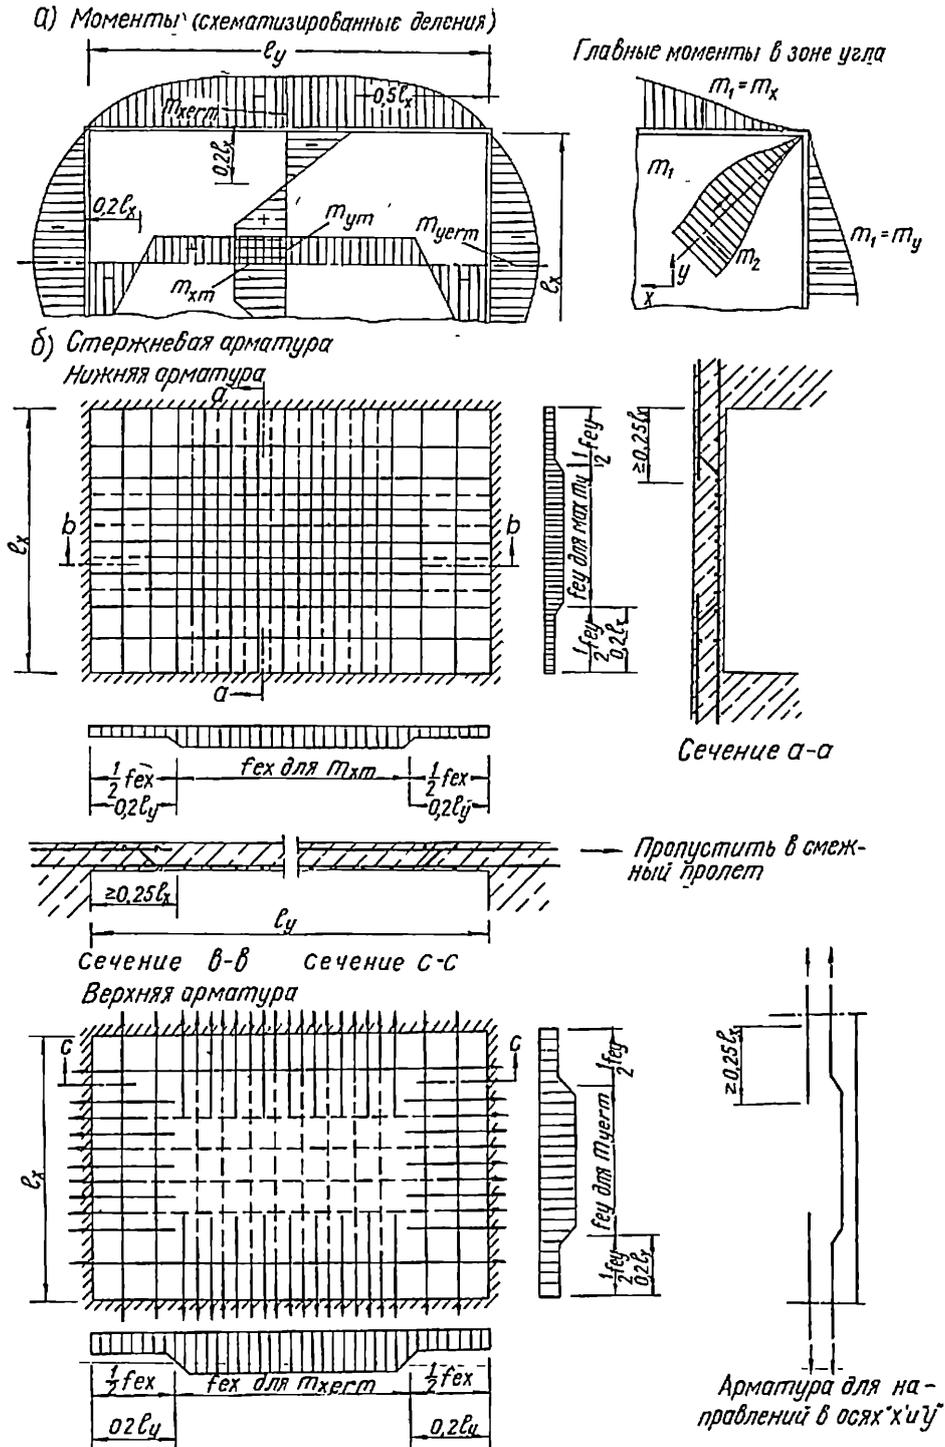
24. Стержневая арматура защемленной на контуре прямоугольной в плане плиты. Армирование сетками
